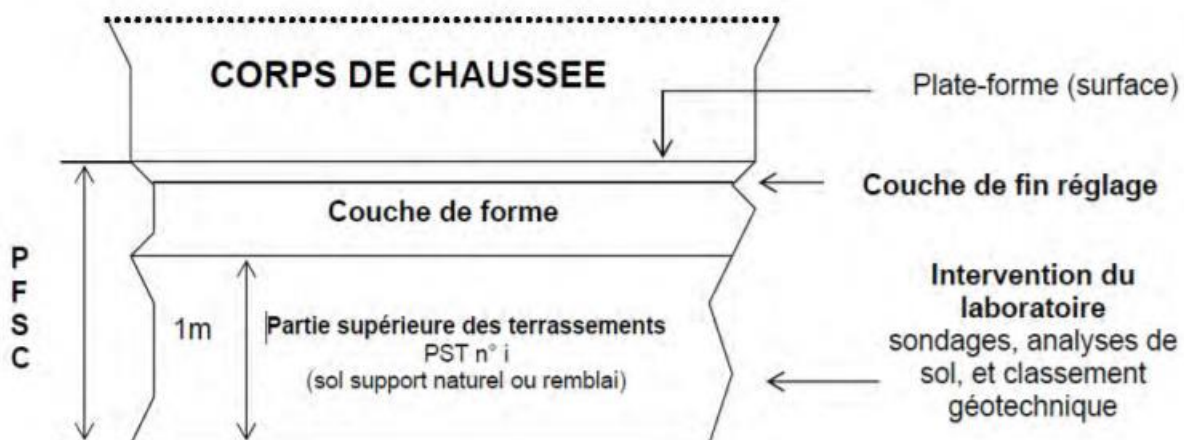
Schéma de la structure de la plate-forme support de chaussée (PFSC). [16]
